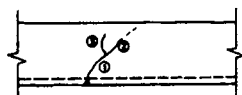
Progreso de una grieta de flexión en diversas etapas de carga. La grieta ha nacido en la base inferior y ha llegado primeramente a (1); con un aumento de carga se ha extendido hasta (2), y, en último término, ha sobrepasado (2) y se ha ramificado en (3).
